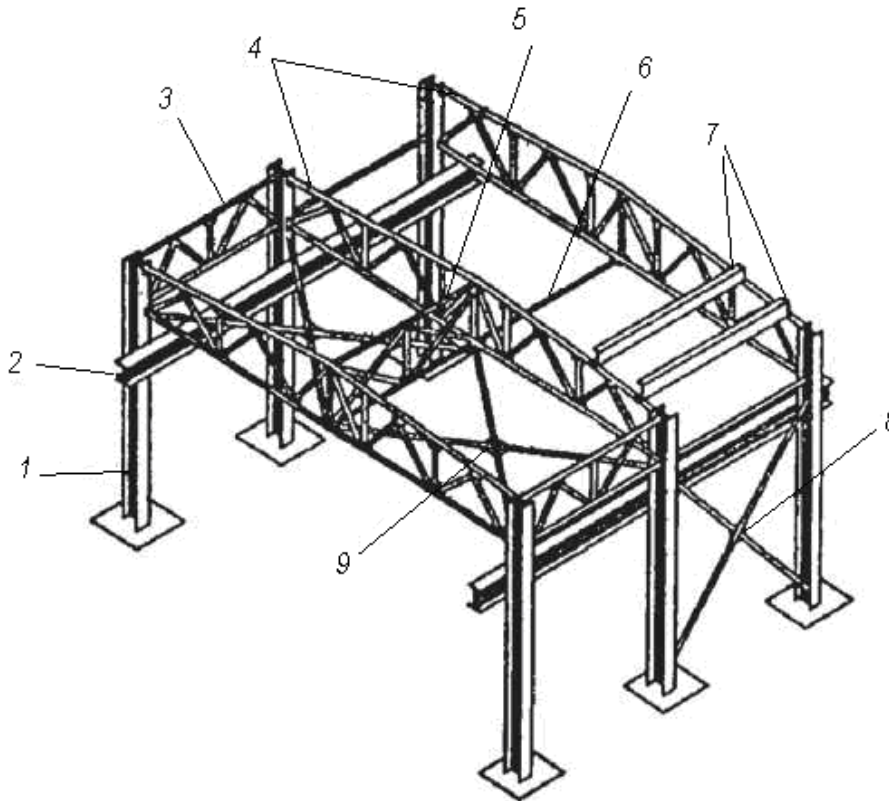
Елементи сталевого каркаса: 1 – колони; 2 – підкранові балки; 3 – вертикальні зв’язки між фермами; 4 – кроквяні ферми; 5 – вертикальні зв’язки (в гребені ферми); 6 – розтяжки (на рівні нижнього поясу ферм); 7 – прогоны; 8 – вертикальні хрестові зв’язки (між колонами); 9 – горизонтальні хрестові зв’язки (на рівні нижнього поясу ферм)
